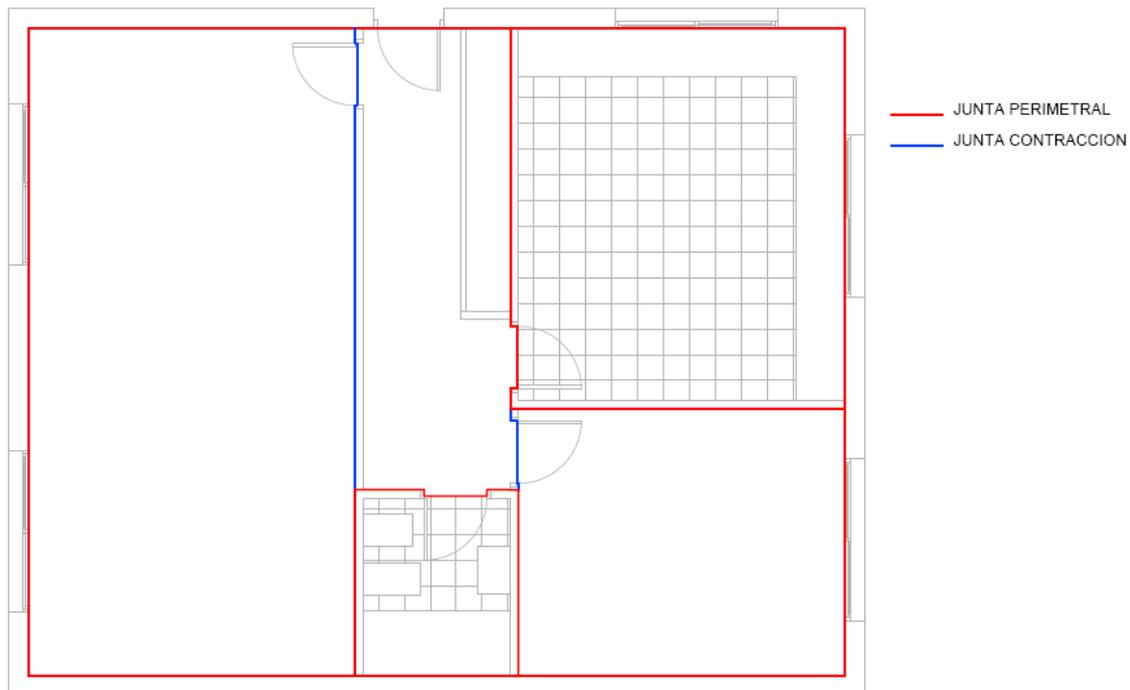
Ejemplo de juntas en pavimentos ejecutados previamente a la tabiquería
